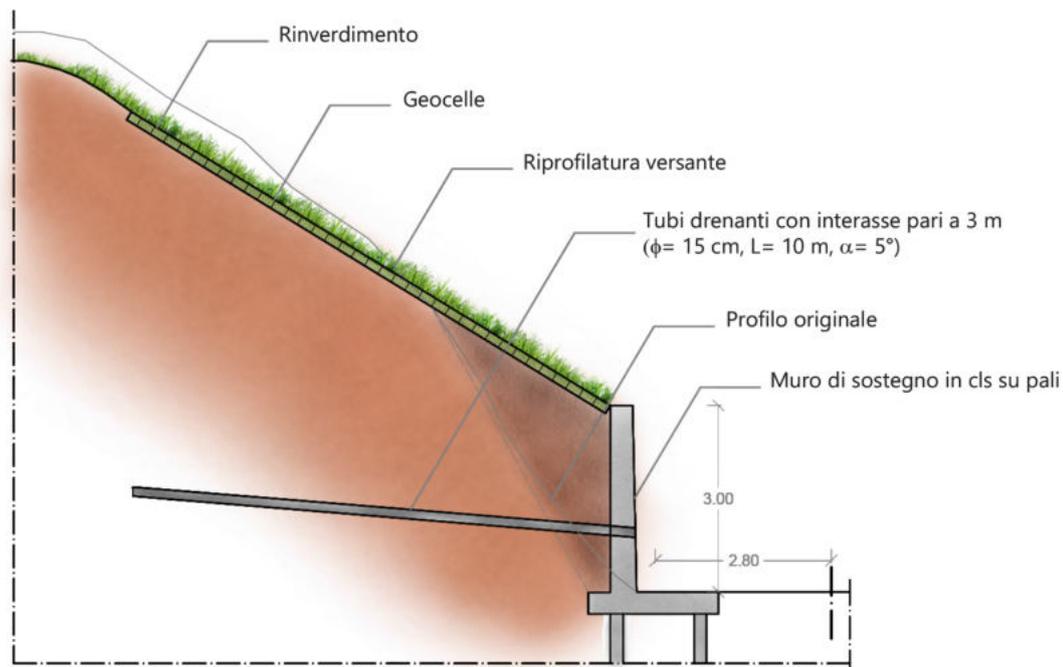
Sezione tipo dell'intervento previsto in zona 7.
